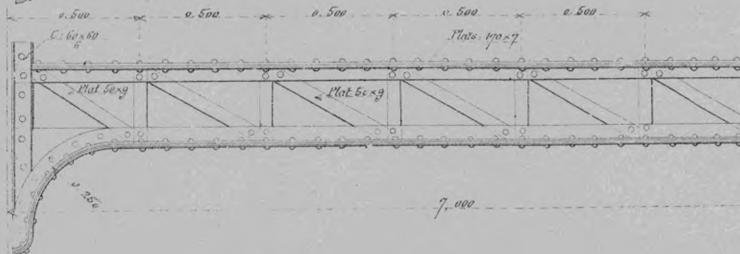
Elevation générale (Echelle 0,01 p.m.)
